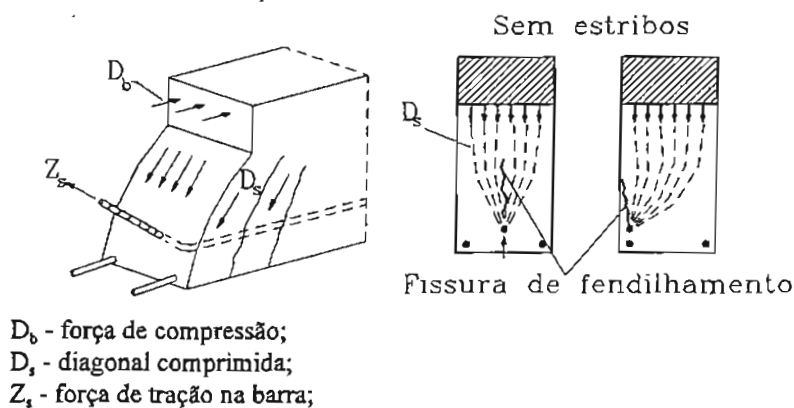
Barras dobradas e o problema de fendilhamento
